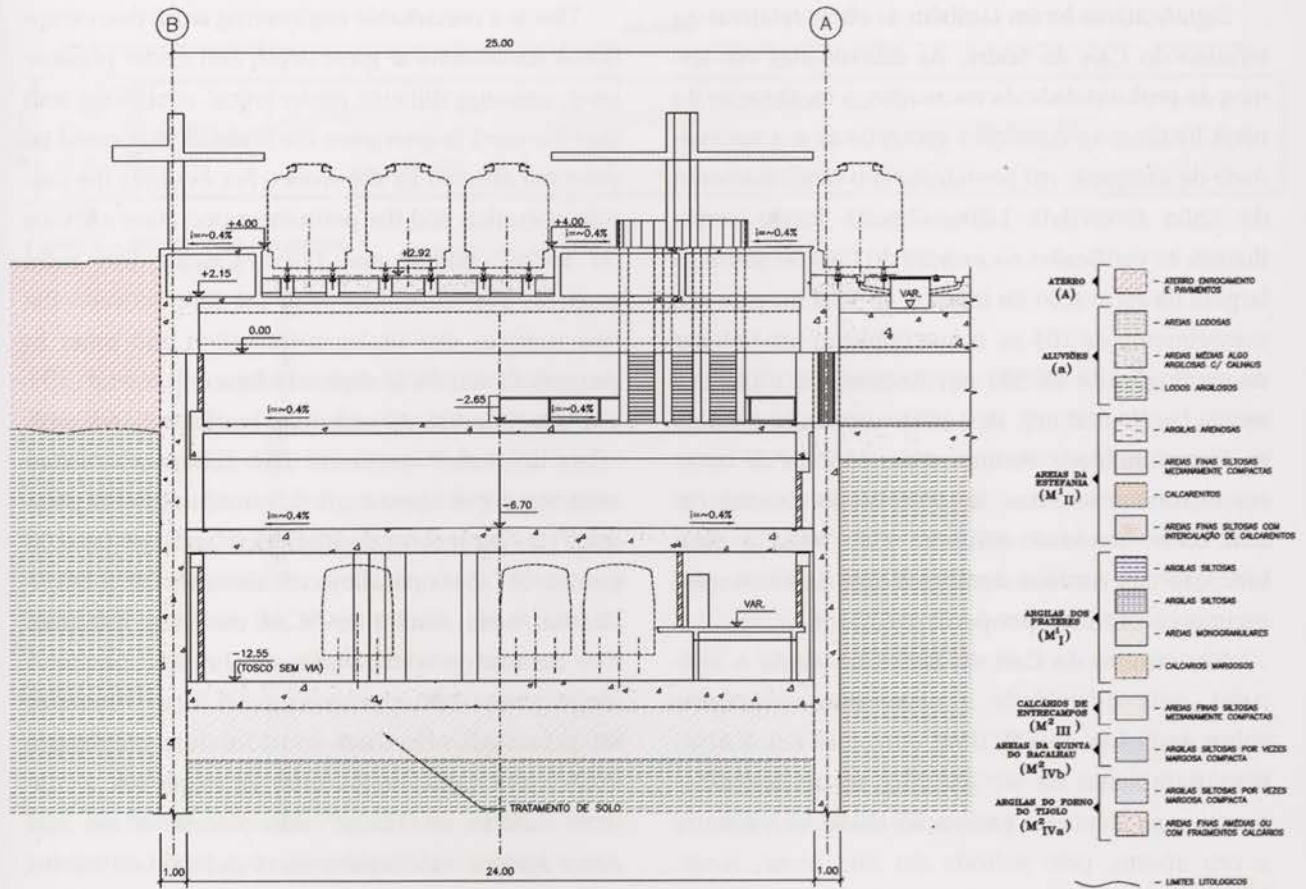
Corte transversal da estação do Cais do Sodré da CP
